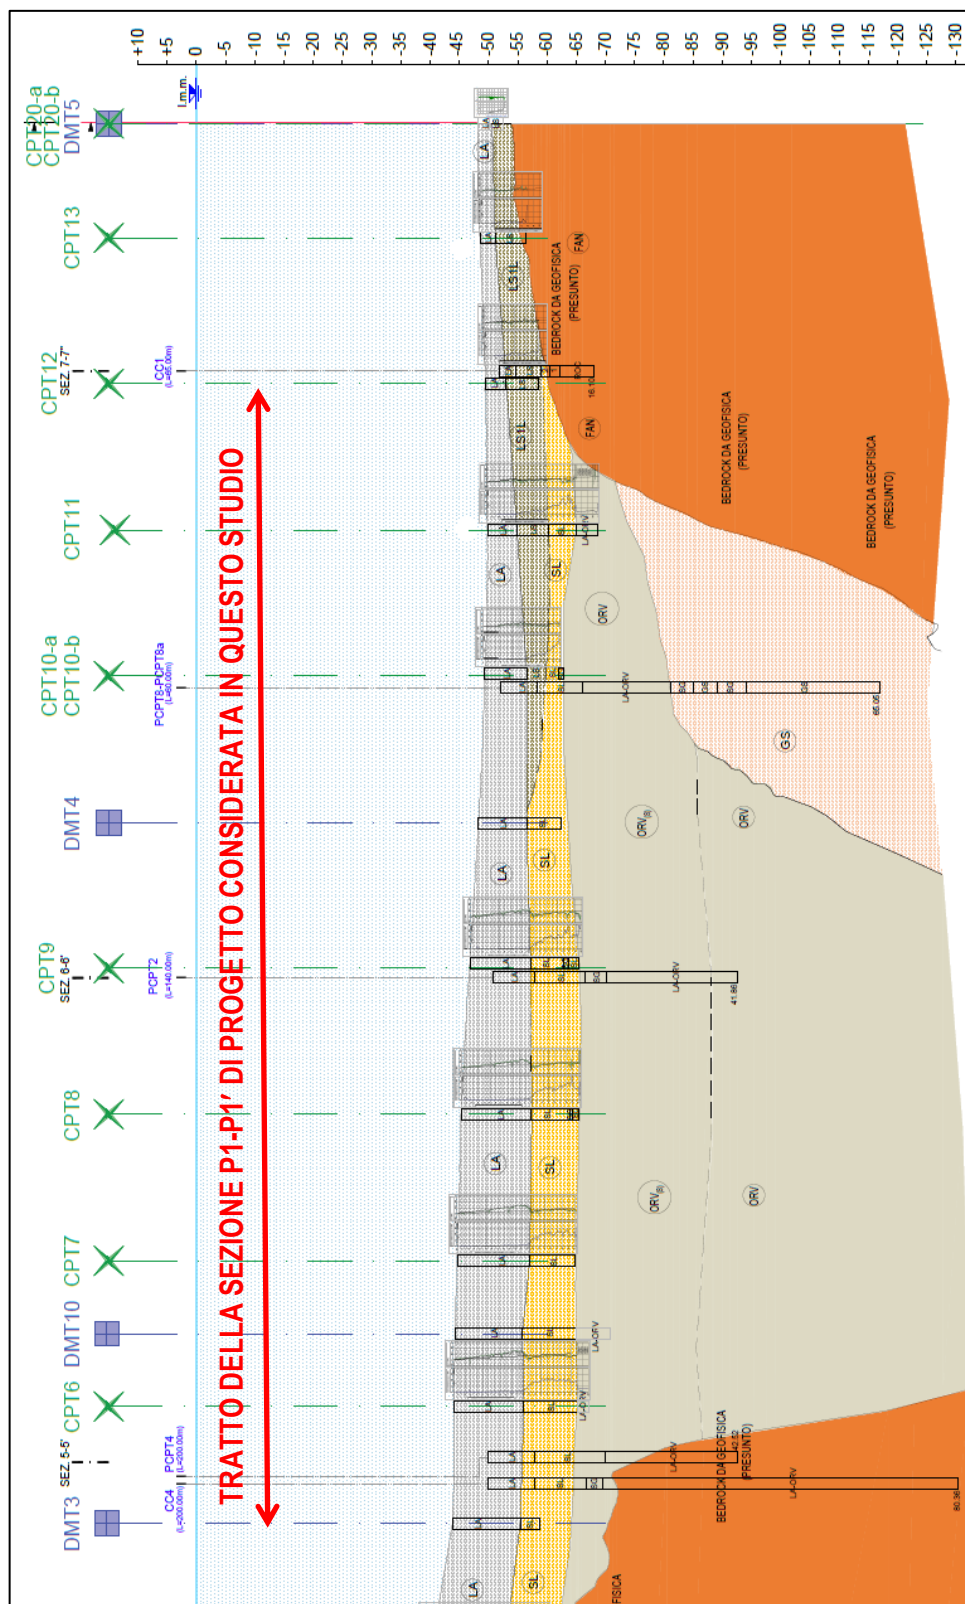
Sezione geotecnica di calcolo P1-P1' ([DC22], [DC23])
